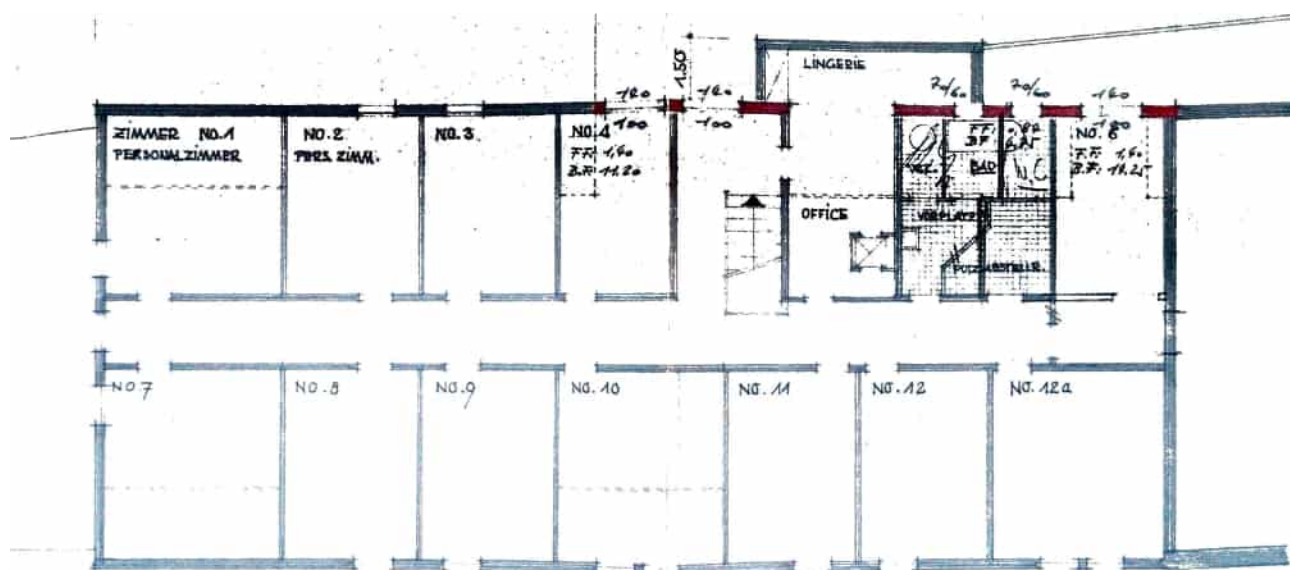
Grundriss des Dachgeschosses des Kernbaus von 1862, Zustand 1955 mit Ausbauplan. Gast- und Personalzimmer.
